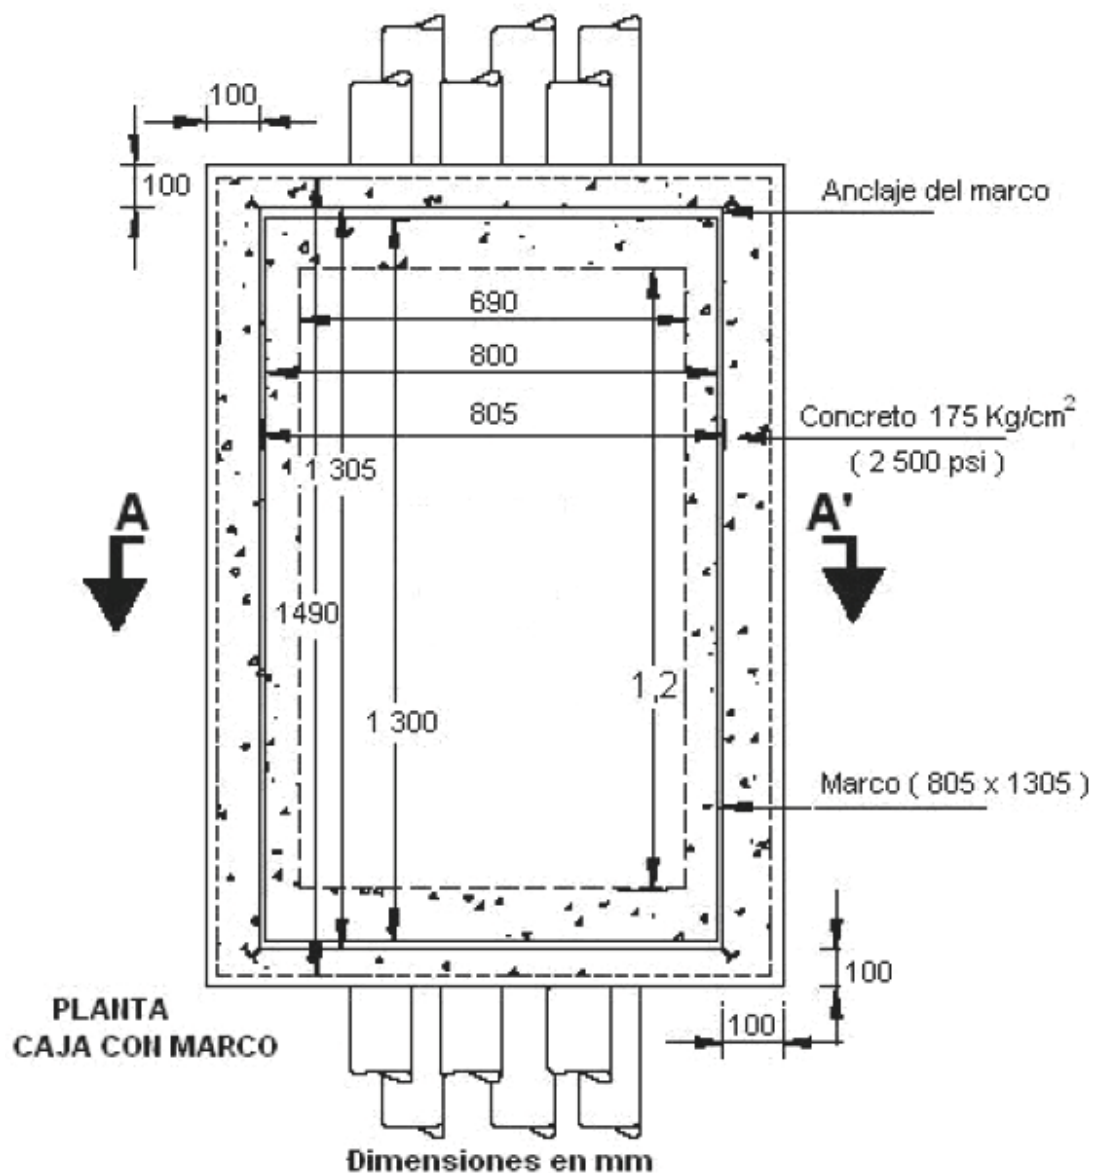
Caja de inspección MT, vista de planta con marco.
